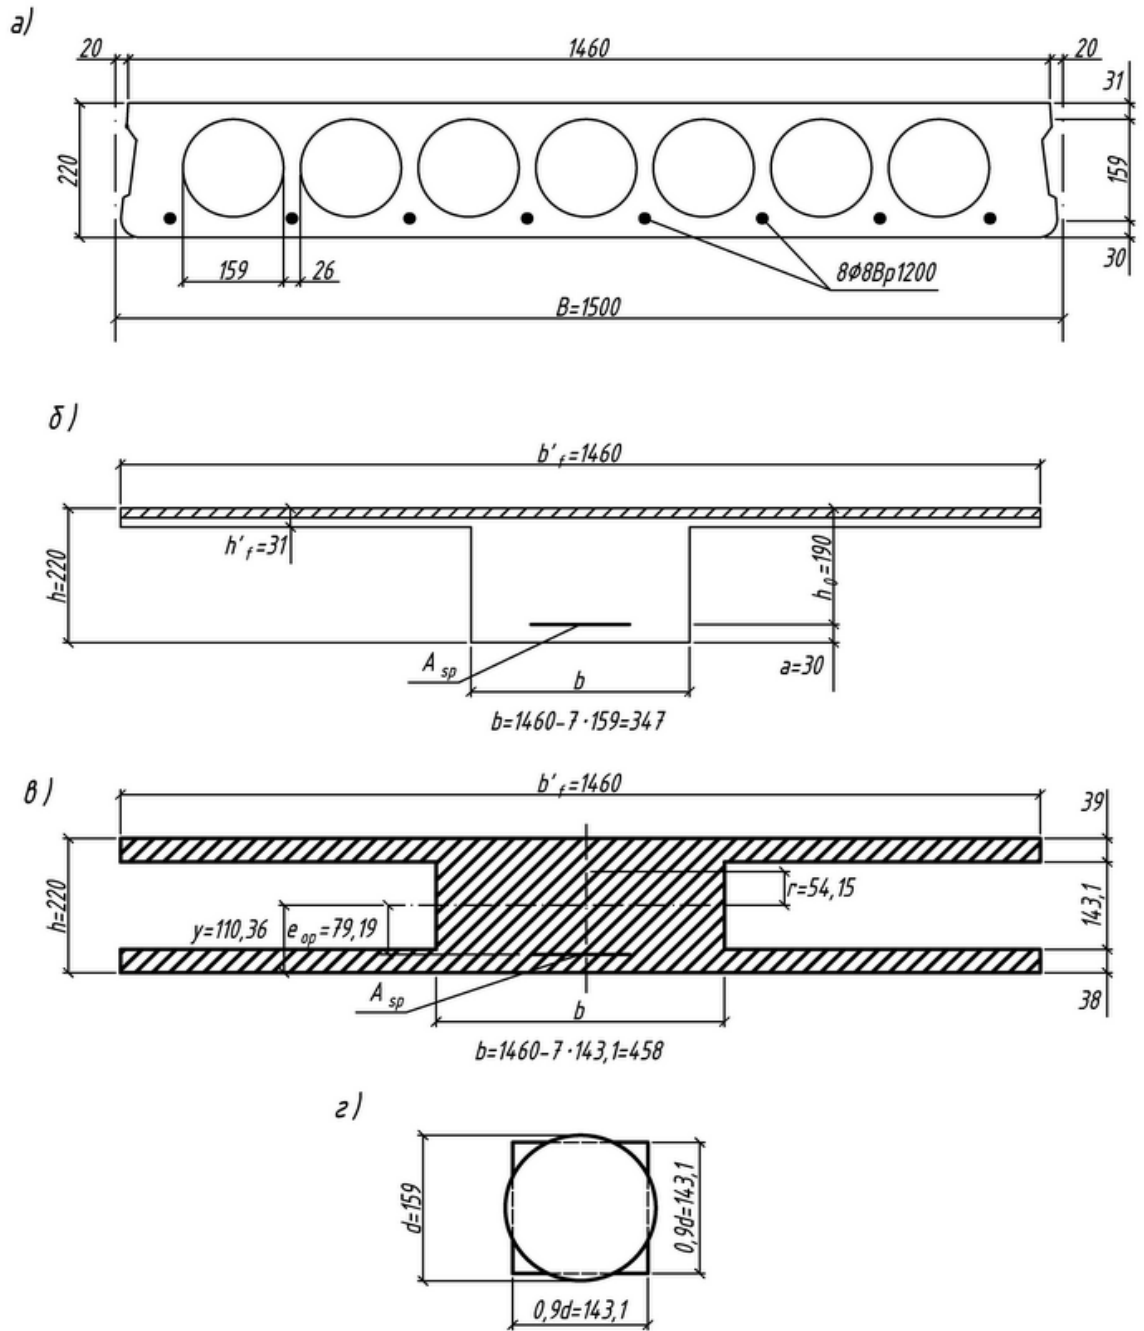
Поперечные сечения плиты с круглыми пустотами:
